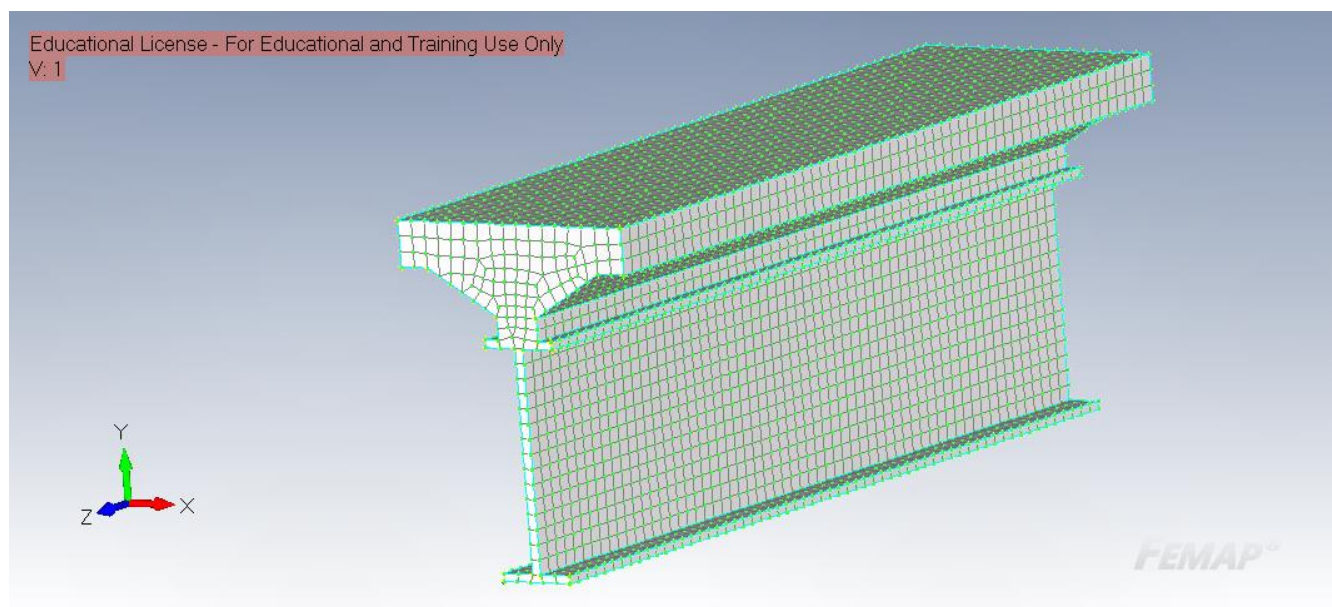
Сталежелезобетонная балка разбита на конечные элементы
